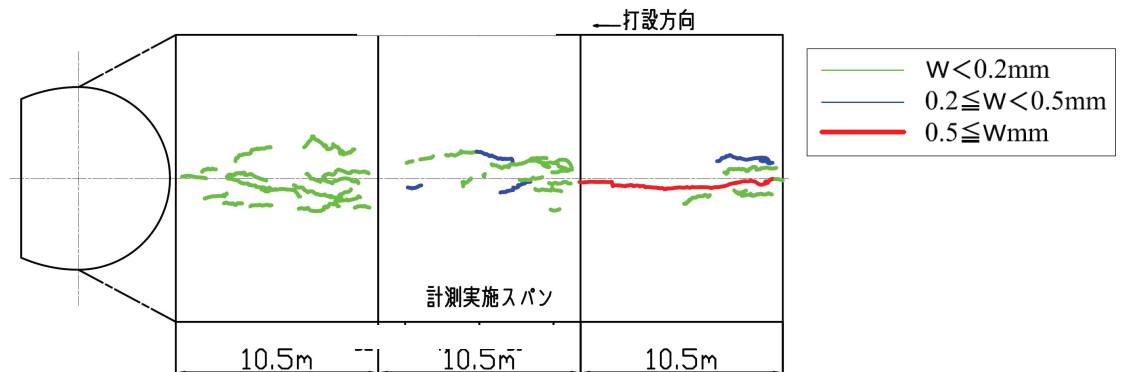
ひび割れの計測箇所（冬期施工）
